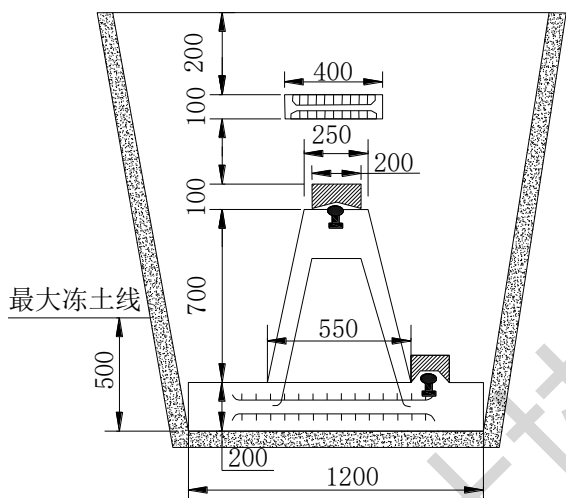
混凝土基本水准基准点标石（单位：mm）
